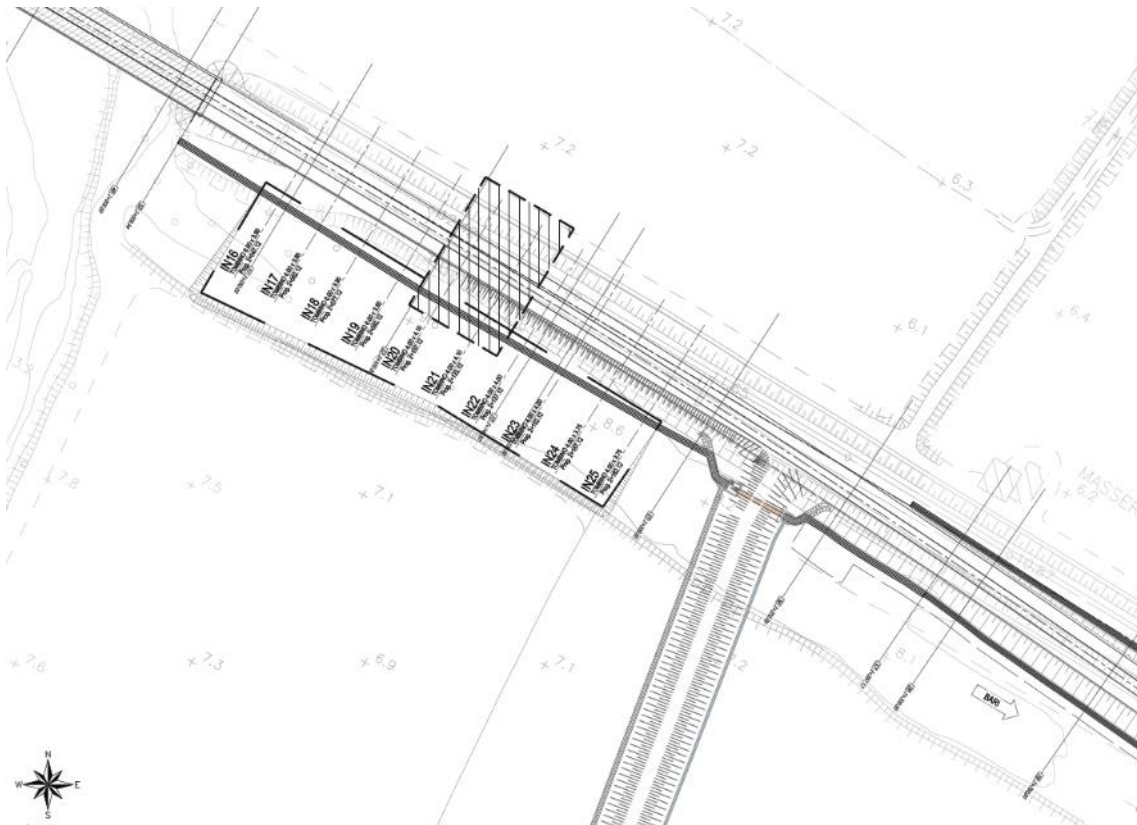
Scatolari in c.a. IN20 ed IN21 – Vista Planimetrica
